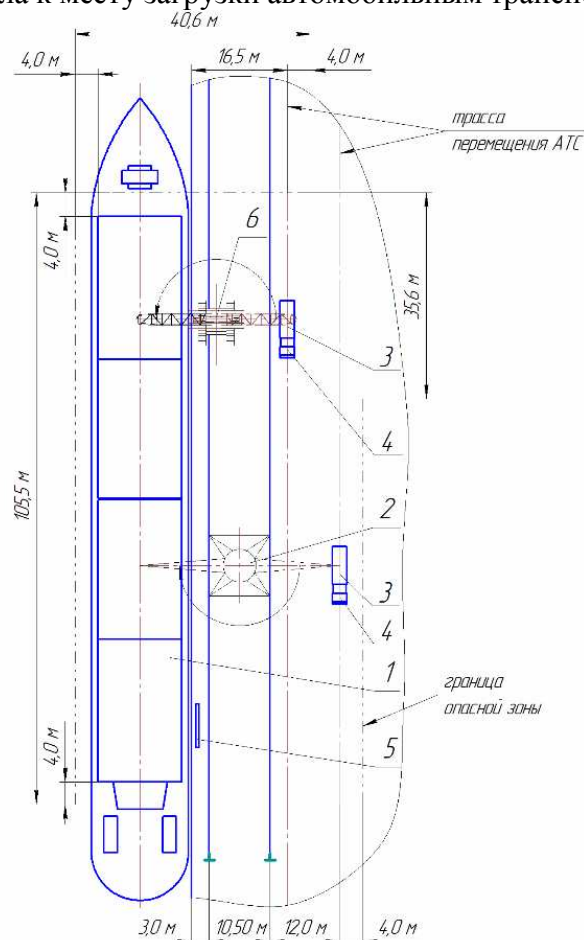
План перегрузочной площадки МЛ5 на МП2: 1 – сухогрузное судно; 2 – порталный кран КПП16/20/32; 3 – контейнер ЯИМН; 4 – АТС; 5 – щит со схемами строповки; 6 – гусеничный стреловой кран МКГС-100
